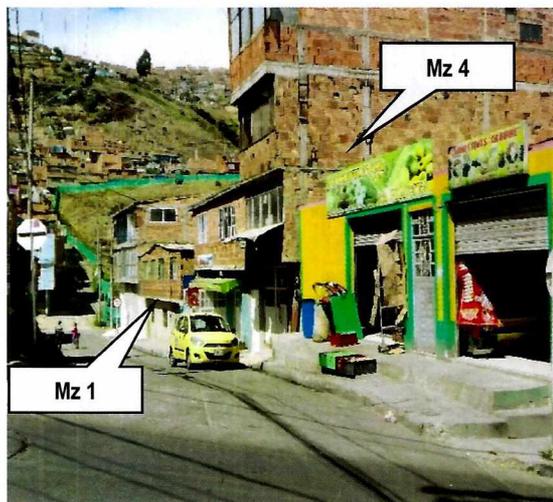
Panorámica Tomada de Este – Oeste Sobre la vía de la Calle 81 b sur y Vista Frontal de los Predios de las Manzanas 1 y 4
